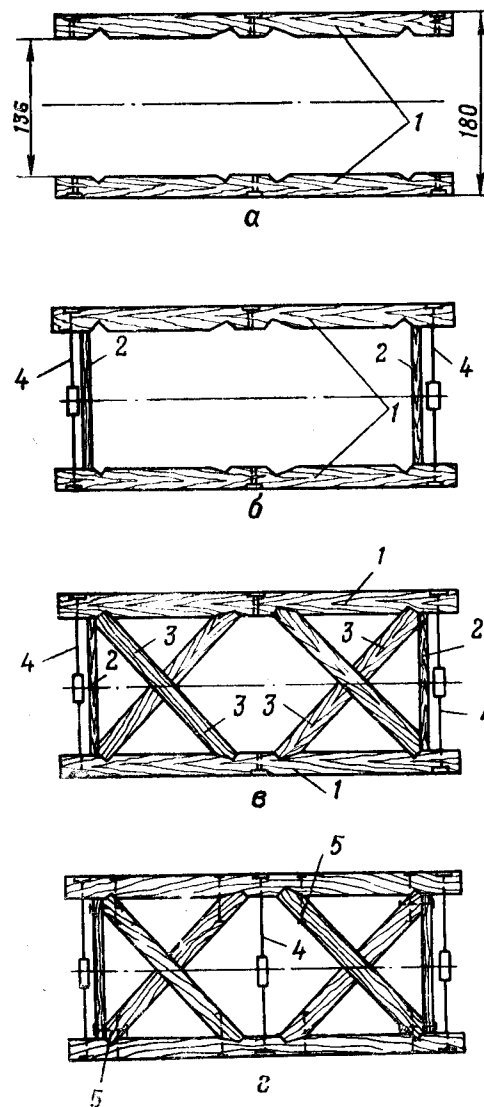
Последовательность сборки стандартной рамы сборной деревянной опоры из брусев:
